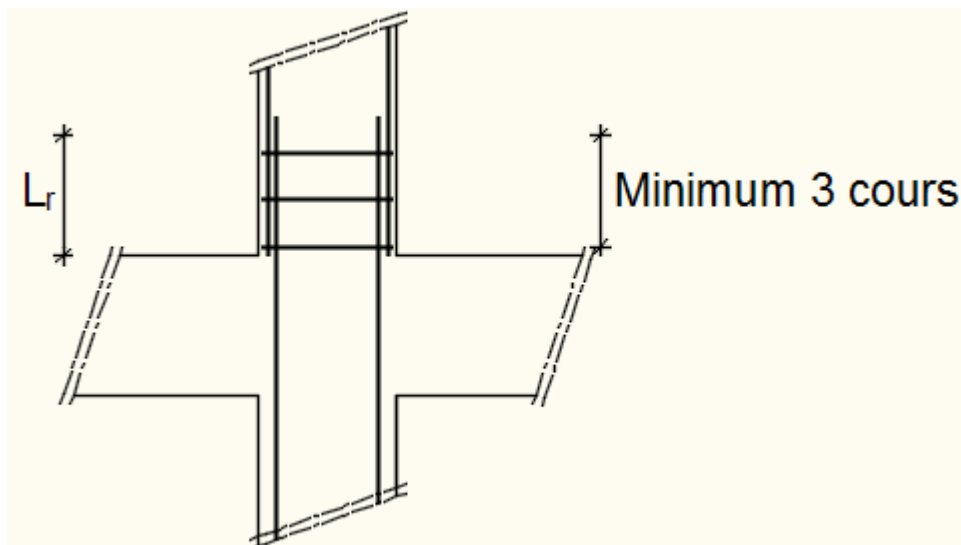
Armatures transversales dans la zone de recouvrement.
